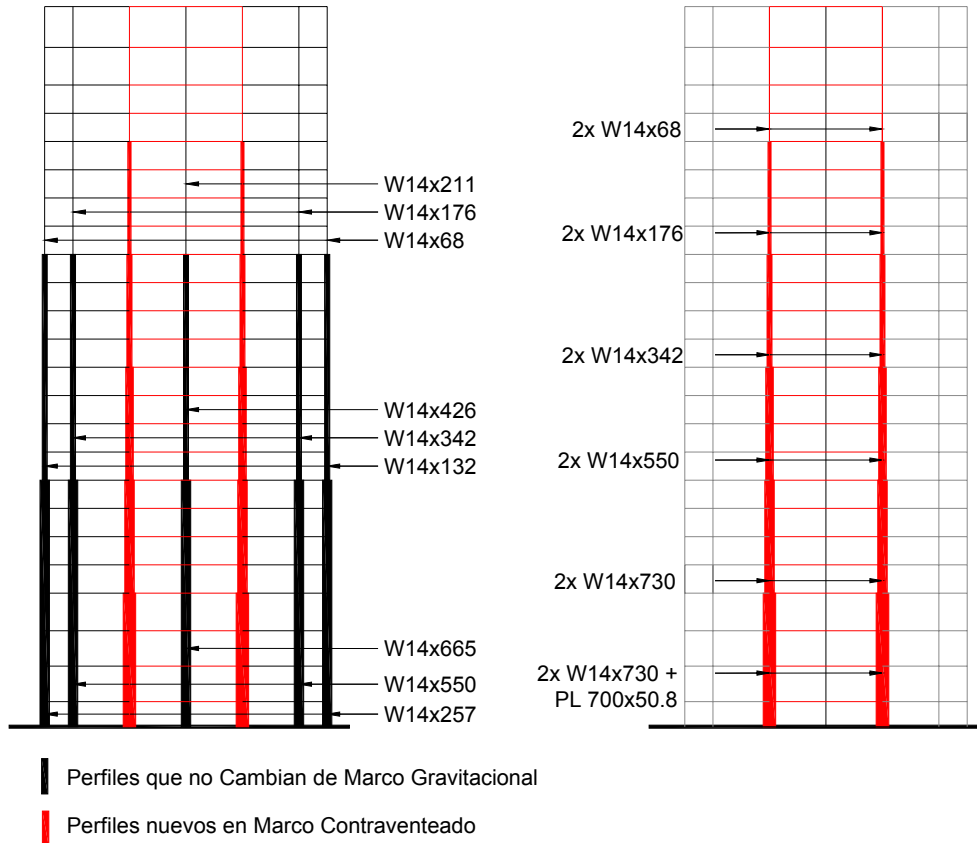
Perfiles de Columnas en Marco Contraventado
